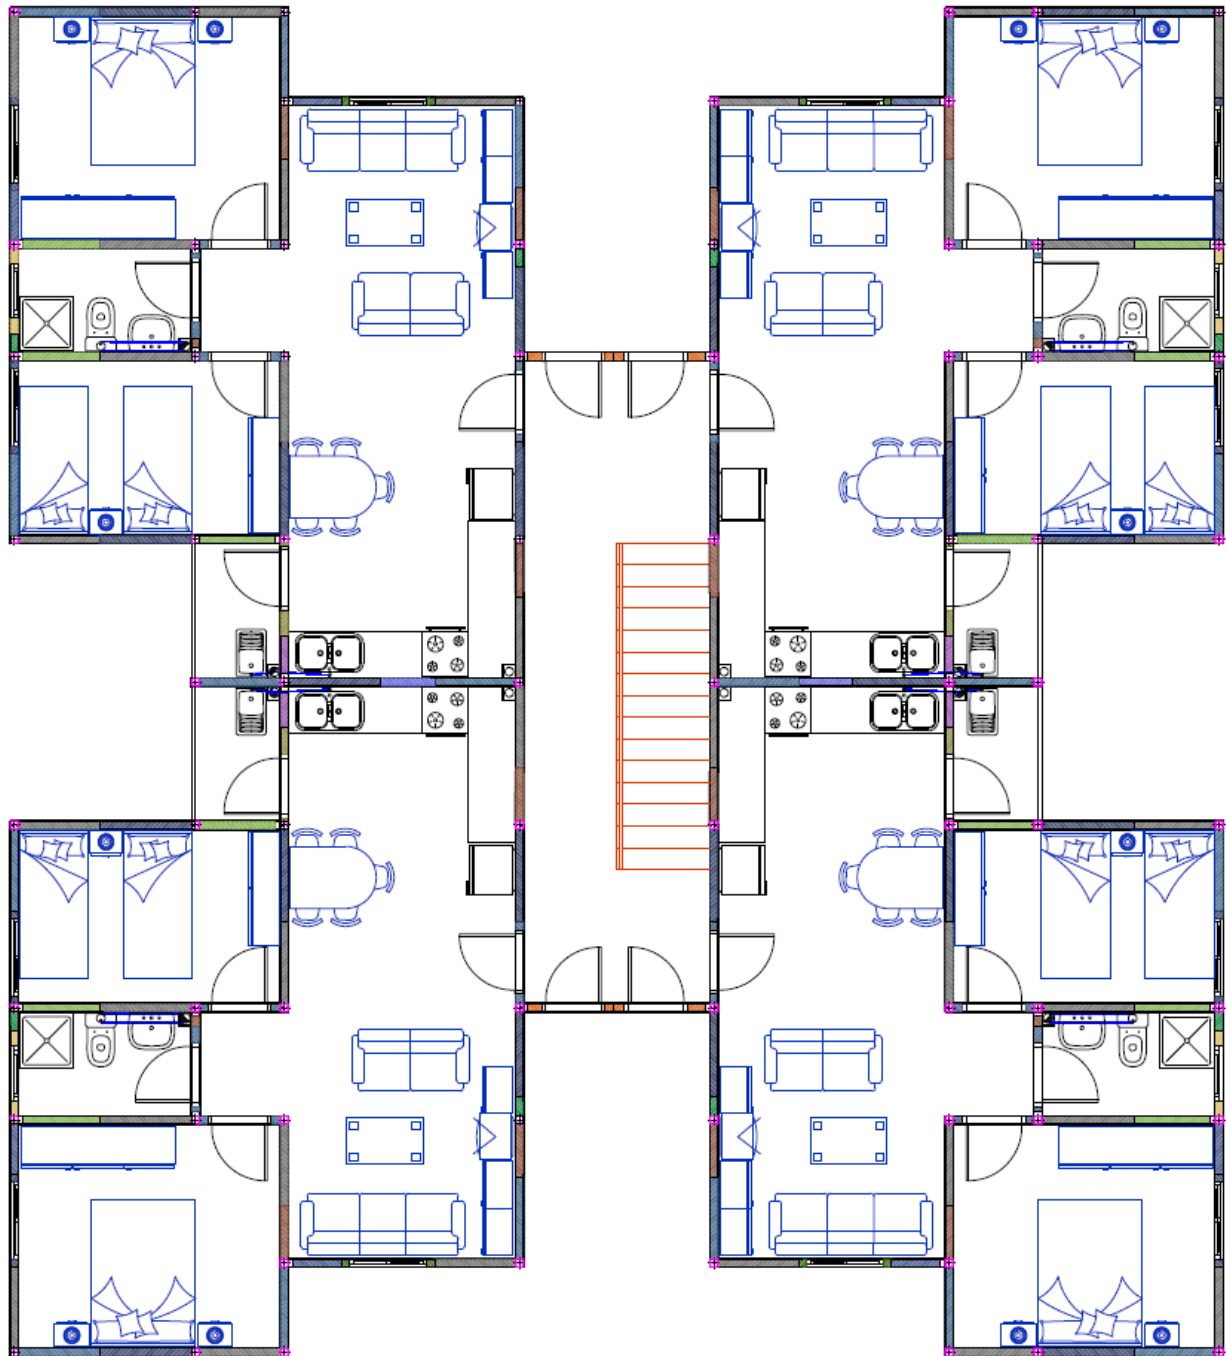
Planta do piso tipo – Caso de estudo C
